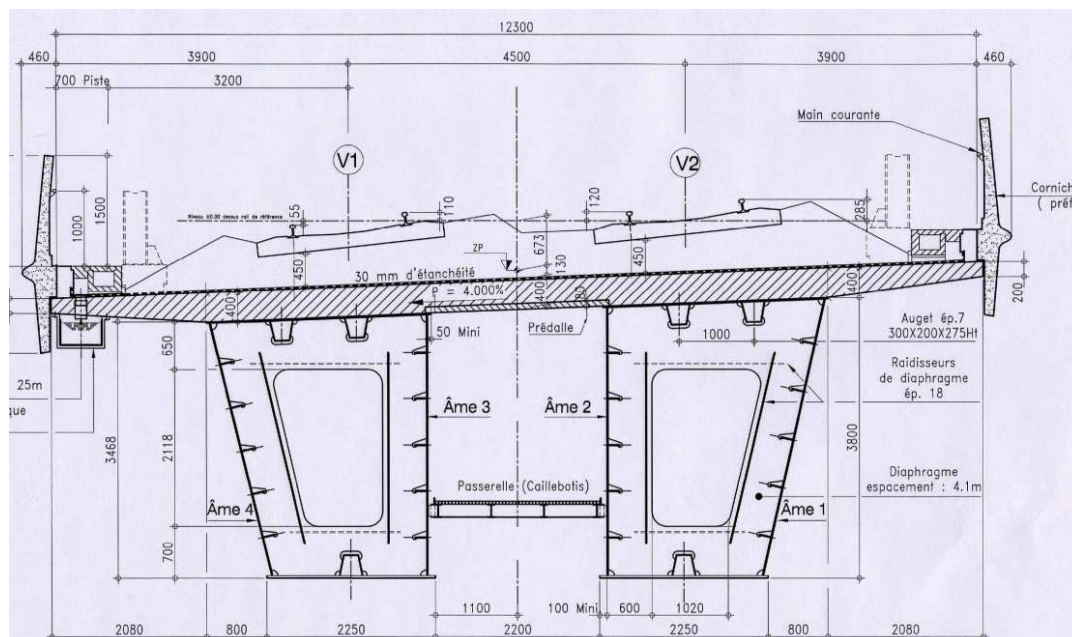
,b: Příčný řez a pohled na typický dvoutrámový ocelobetonový most s dolní ztužující betonovou deskou na VRT (Essômes-sur-Marne), rozpětí 26-35-26 m)
